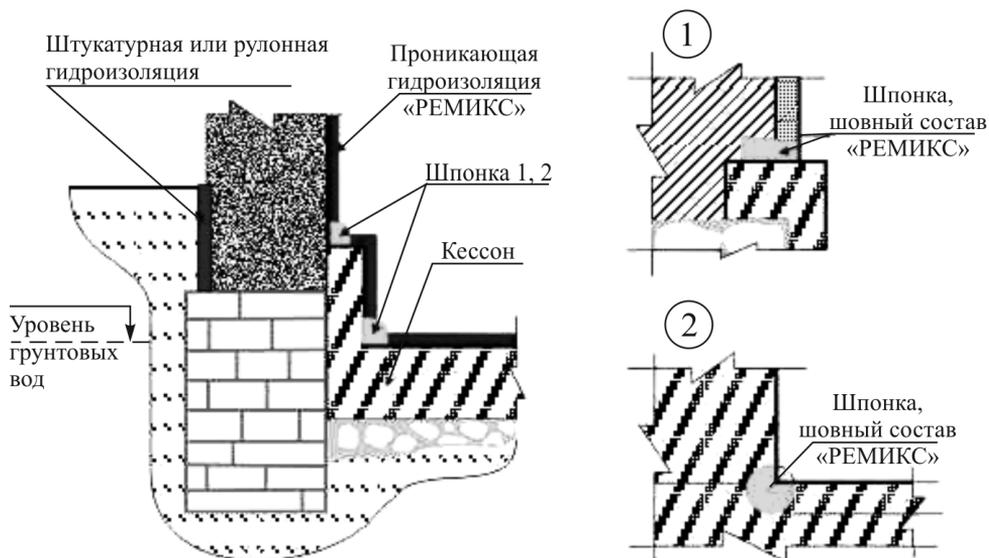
Типовые узлы технологии устройства гидроизоляции для бетонных и железобетонных конструкций с применением сухих противofильтрационных смесей «Ремикс»
